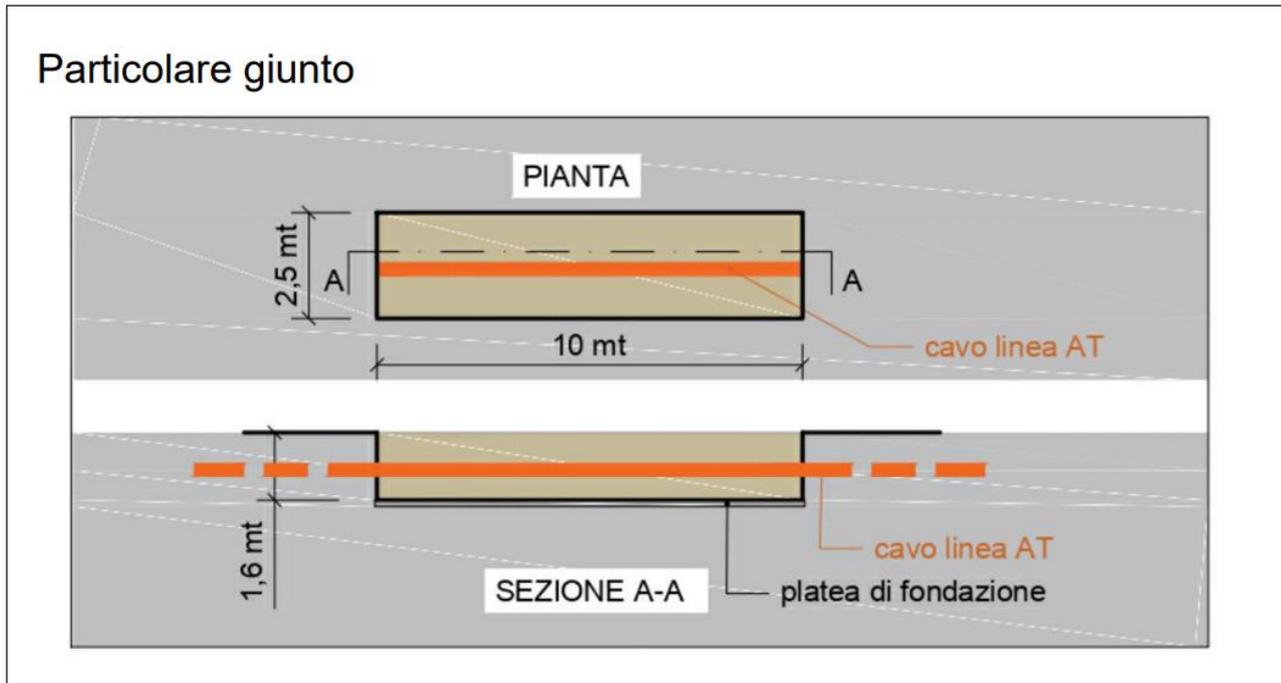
Tipologico pianta e sezione platea di fondazione buche giunto
